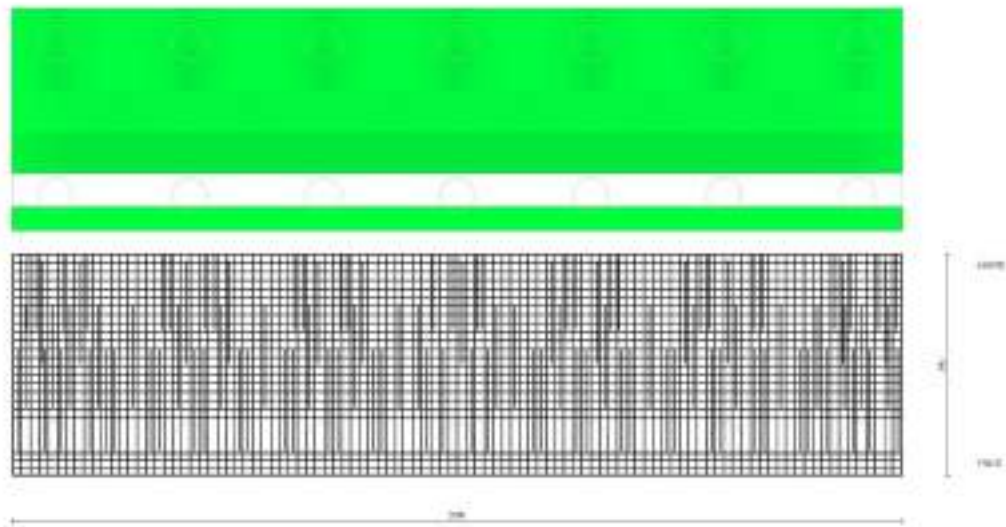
Piastra fondazione dir. X (Inviluppo)
